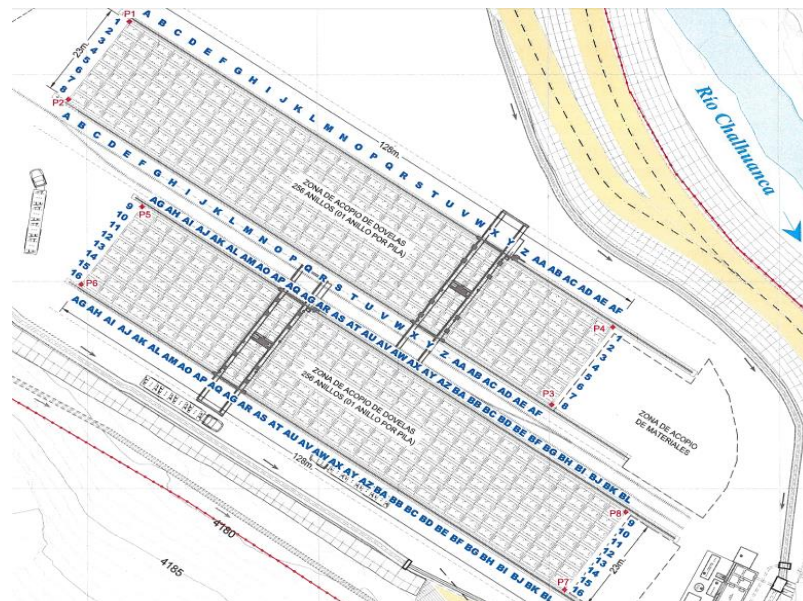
Vista en planta de zona de acopio de dovelas y grúas pórtico
